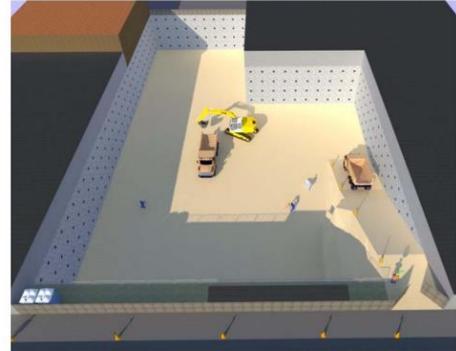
/ Esquema 3d de rampa de acceso. Ref. ilustración 3d Alejandro Escobar
